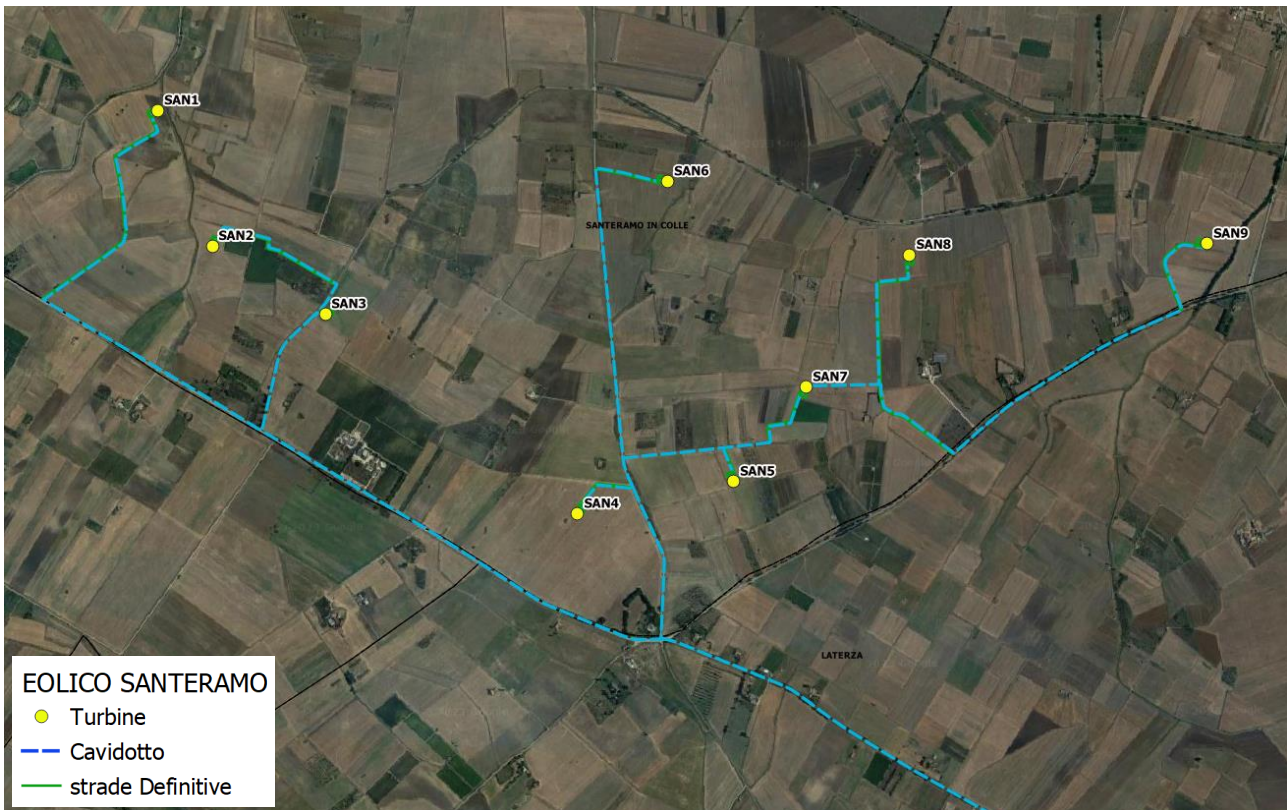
Area di intervento: layout di progetto su ortofoto
